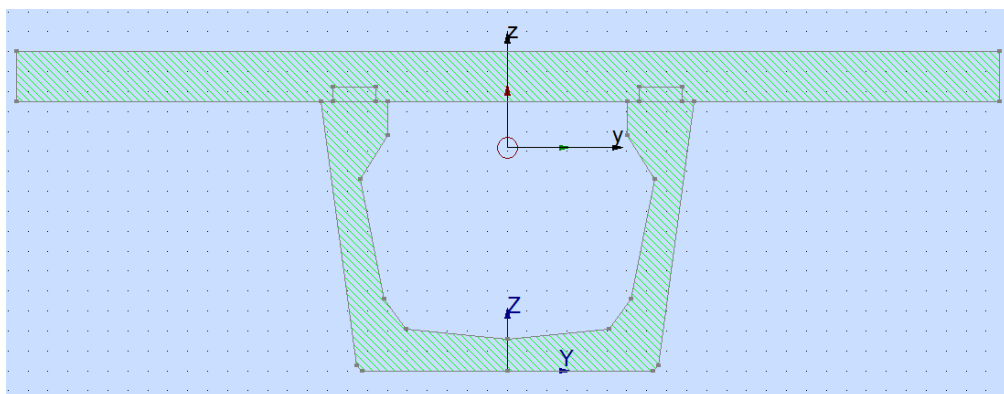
Propriedades da secção transversal viga/laje do tabuleiro
